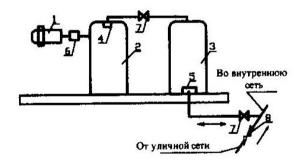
Пневматическая установка с двумя баками: I – компрессор; 2 – воздушный бак; 3 – водяной бак; 4, 5 – клапаны; 6 – фильтр; 7 – запорная арматура; 8 – обратный клапан
